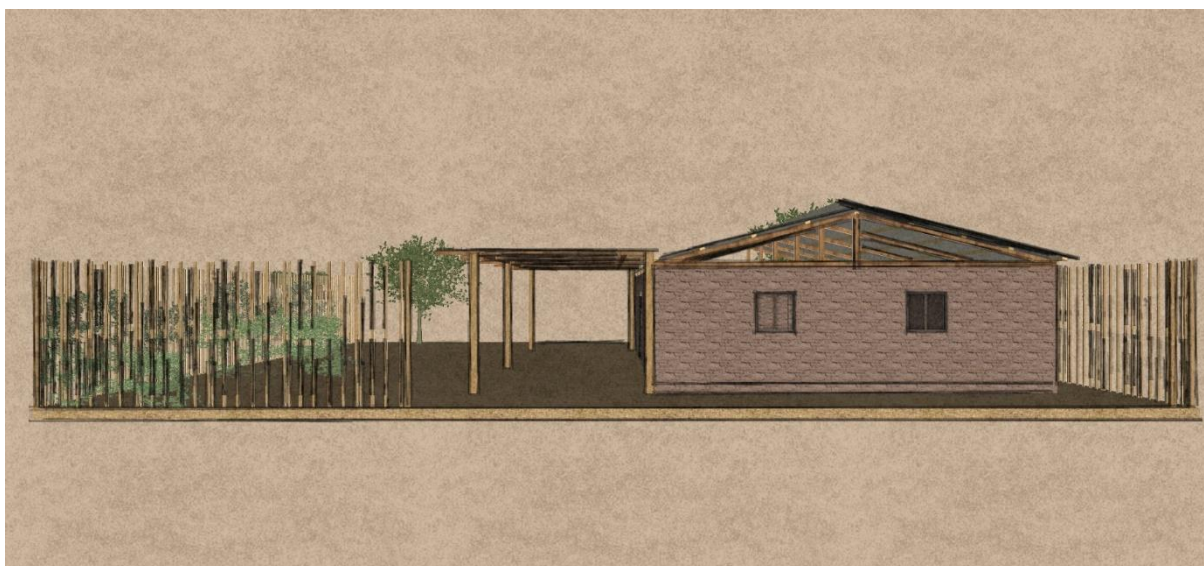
Vivienda tipo flexible en San Isidro – *elevación*. Fuente propia
